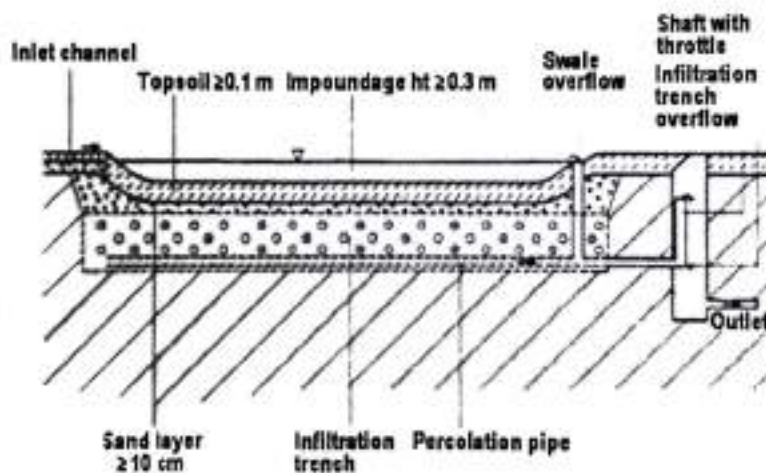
Schema di trincea d'infiltrazione con canale drenante superficiale e tubo di dispersione
